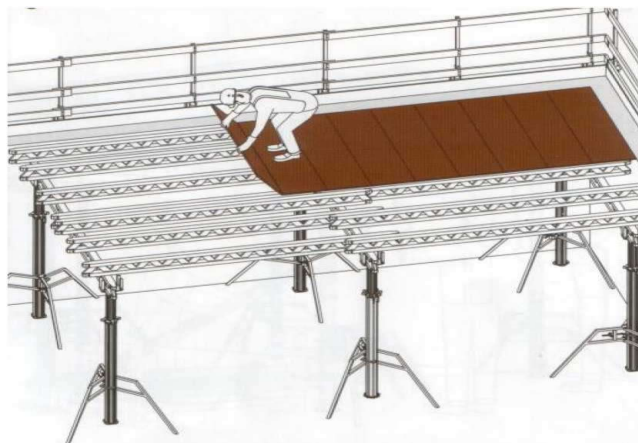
Укладка листов фанеры: 1-поперечная балка; 2-укладываемый щит; 3-уложенный и закрепленный щит; 4-ограждение по периметру возводимого перекрытия
